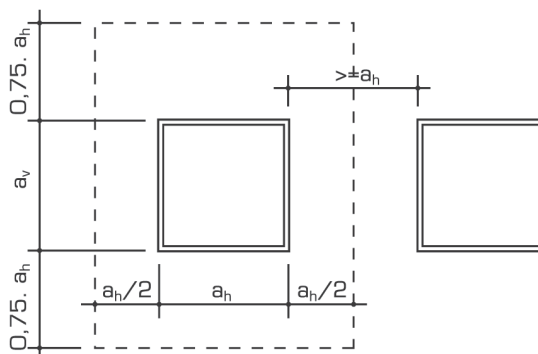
Ilustração de distribuição horizontal de aberturas em uma parede de concreto
